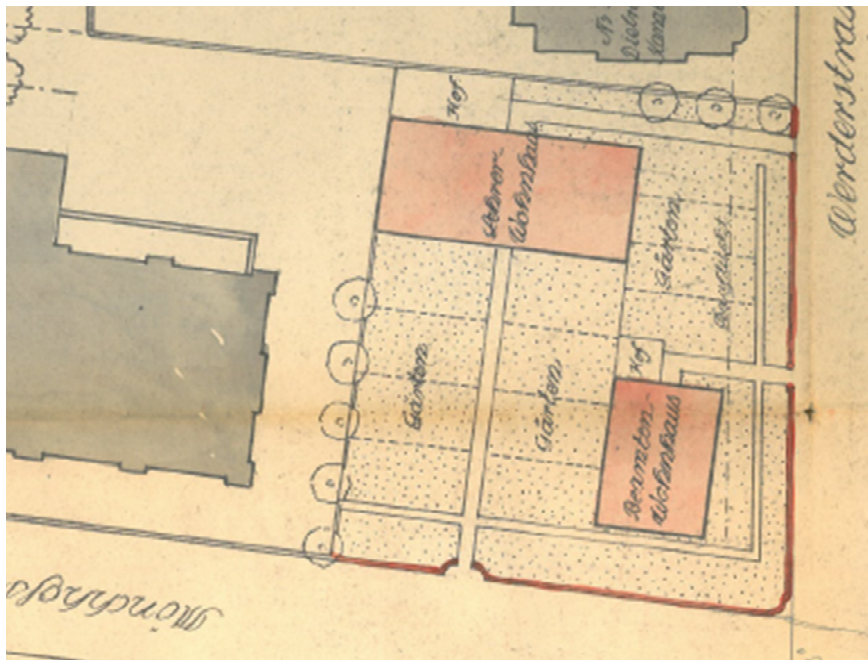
Lageplan von 1921 für den Bau von Lehrer- und Beamtenwohnhaus mit Gärten und Einfriedung
